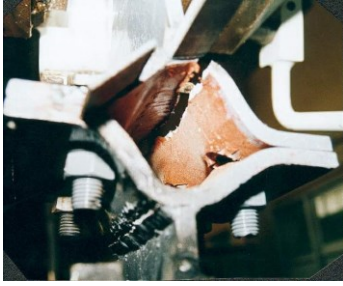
Platine ruiné au droit de semelle tendue et traversée par les Boulons- tp=8mm
